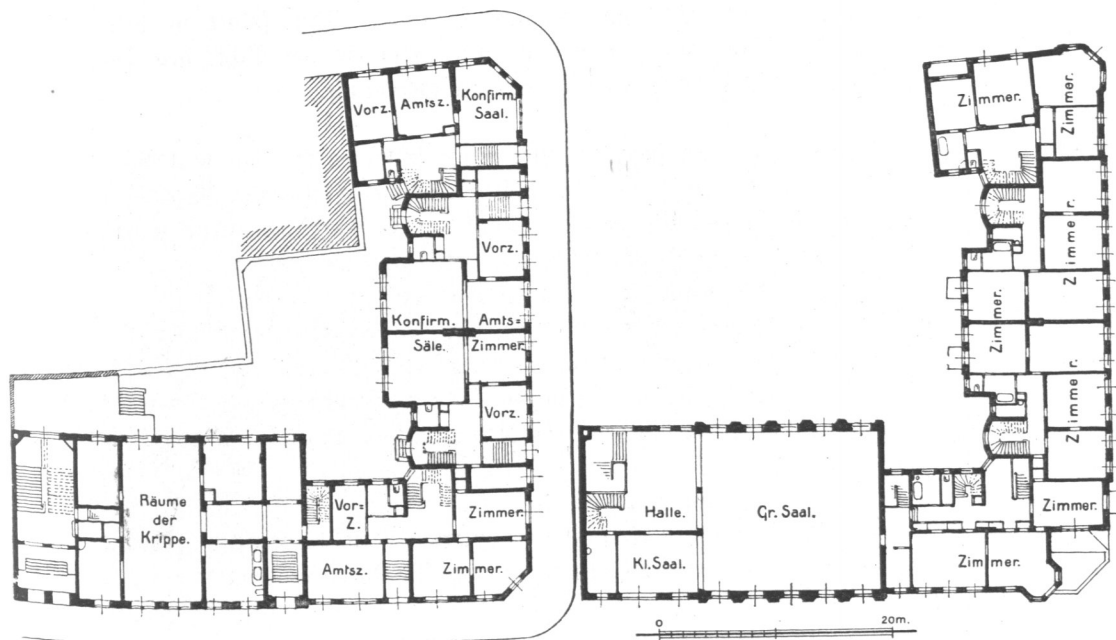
und 171. St.-Jacobi-Pfarrhof, Grundrisse.
